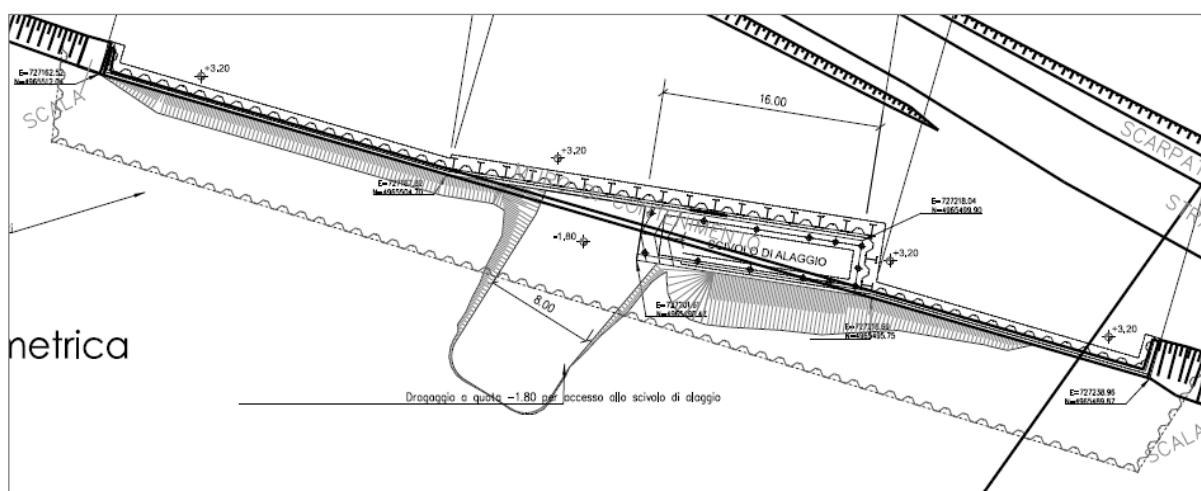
Planimetria del nuovo muro di sponda previsti in sinistra idraulica a monte della nuova biforcazione e comprendente lo scivolo di alaggio
